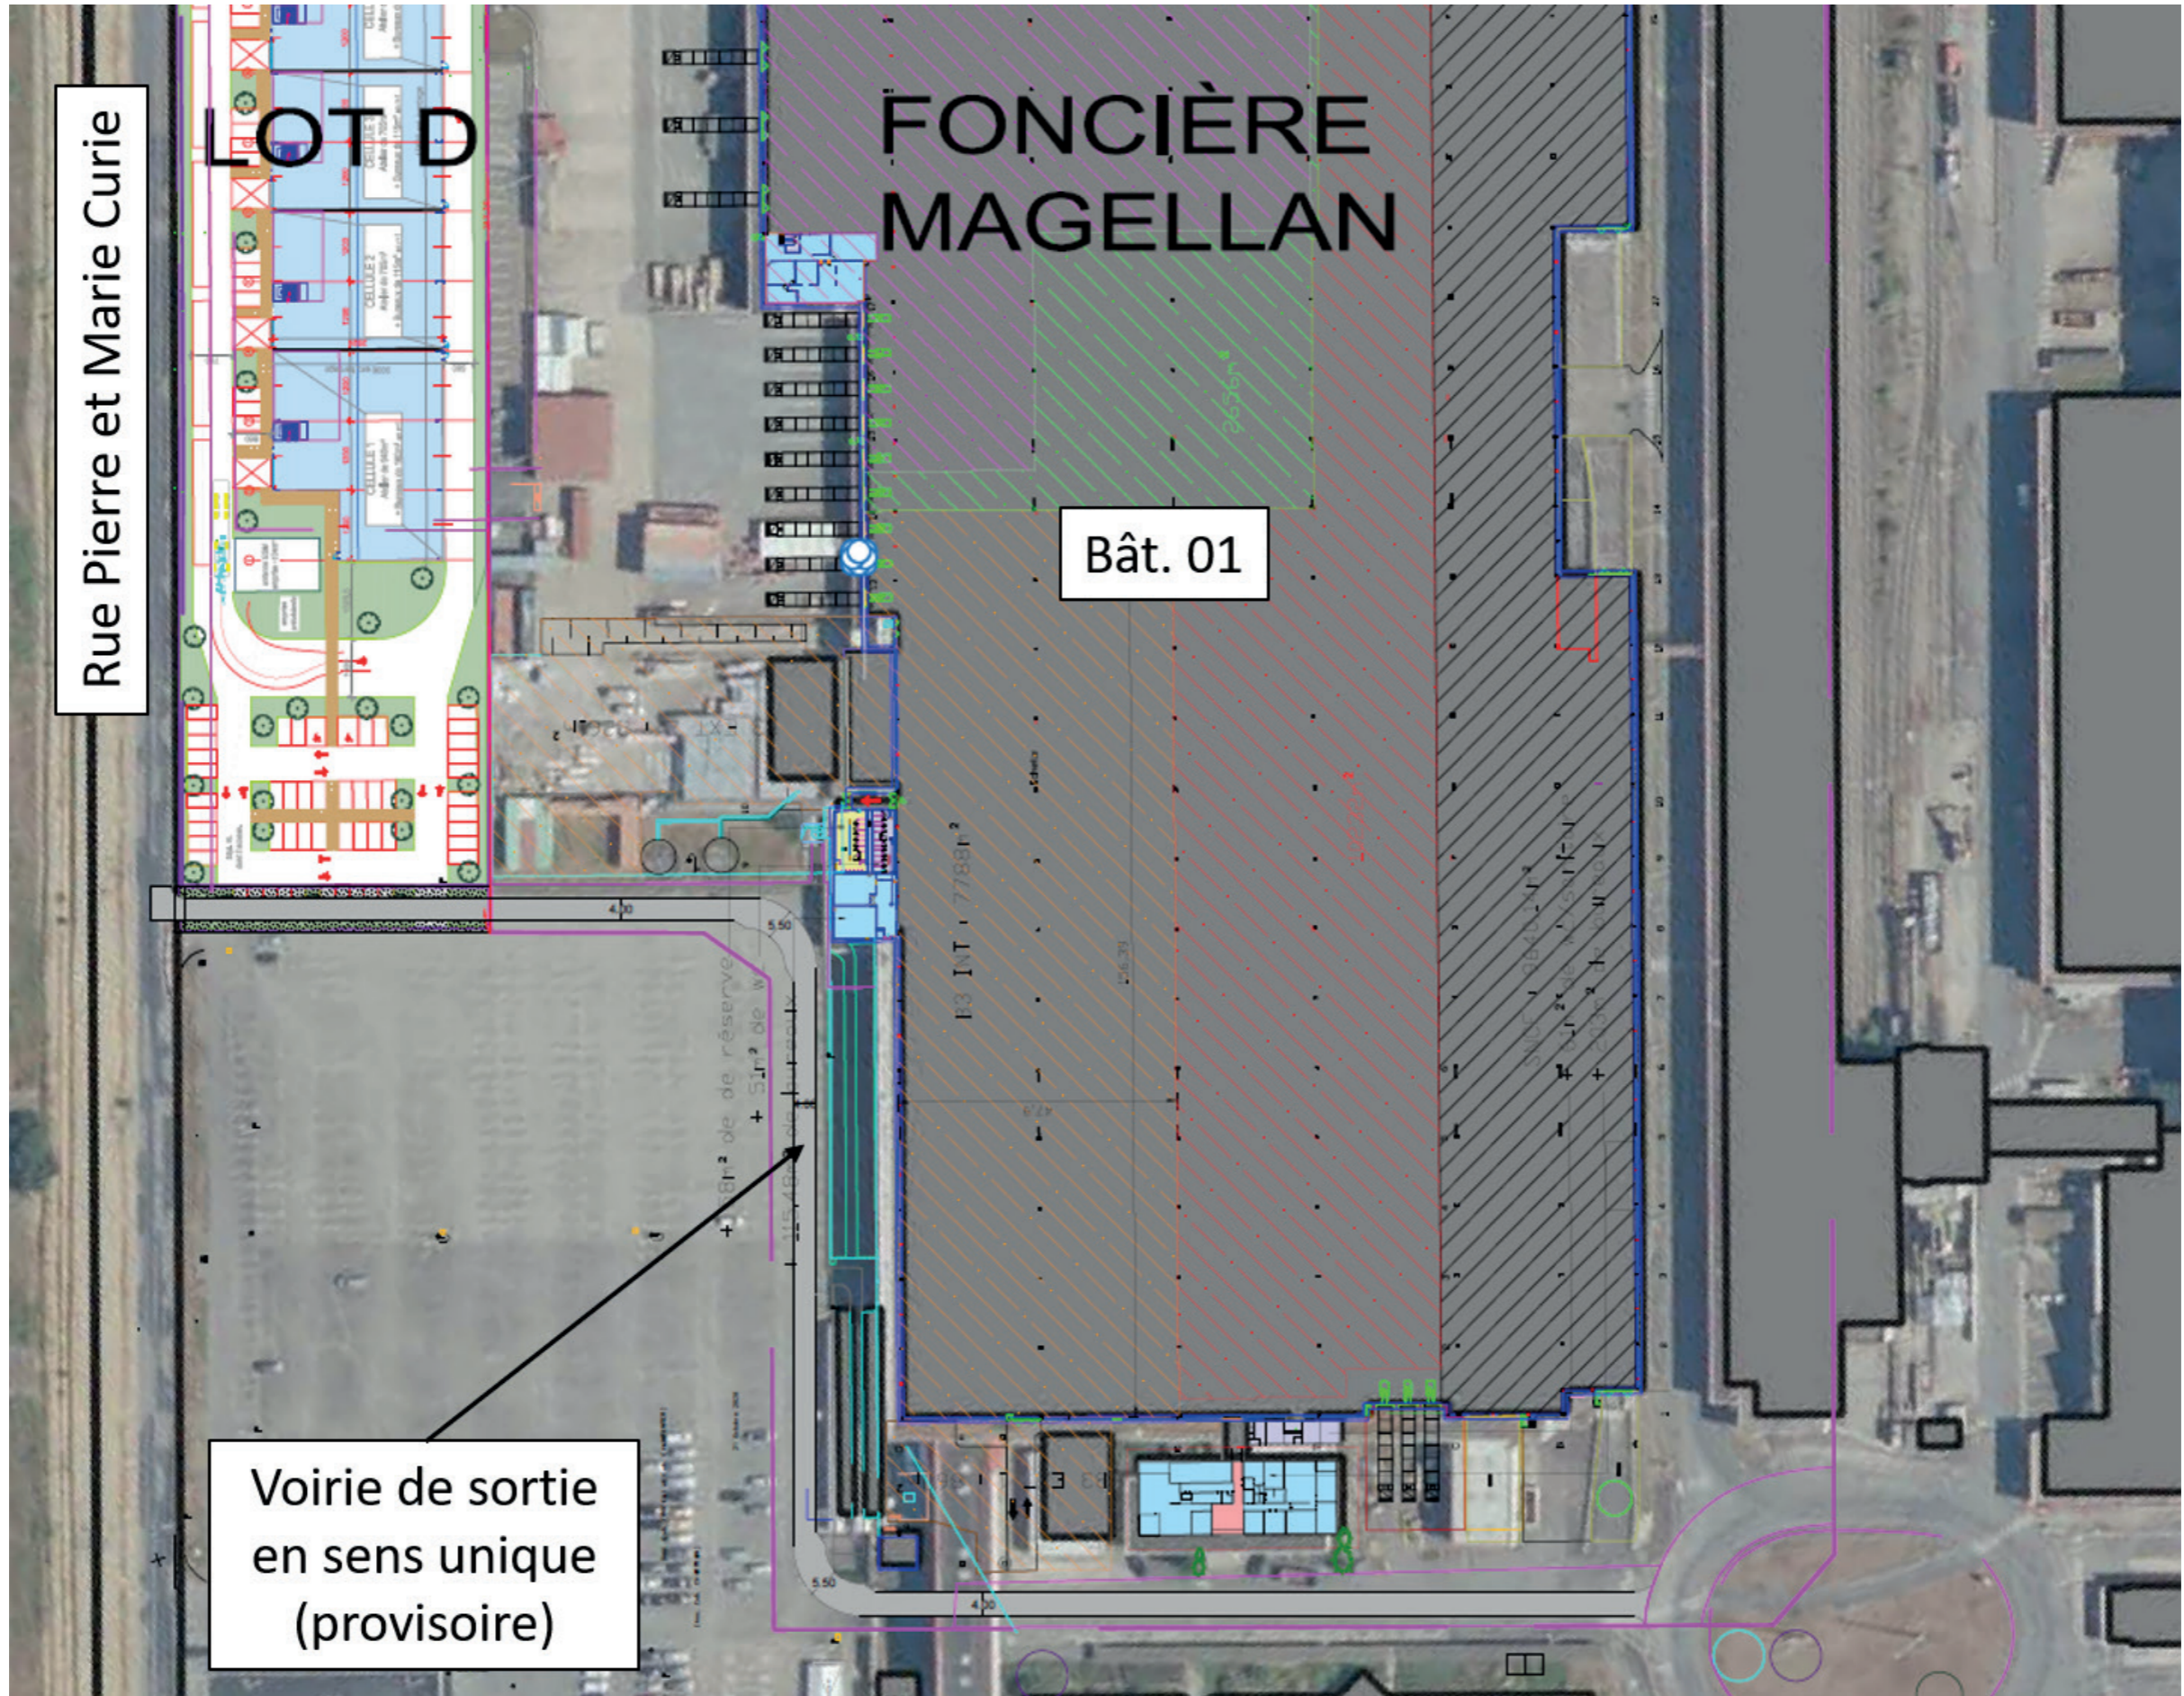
Plan masse du projet annoté - Zoom sur la sortie sud
